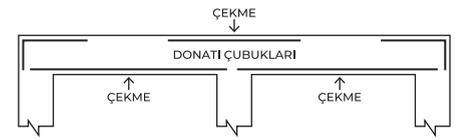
Klasik Betonarme Elemanlarda Tipik Donatı Yerleşimi
